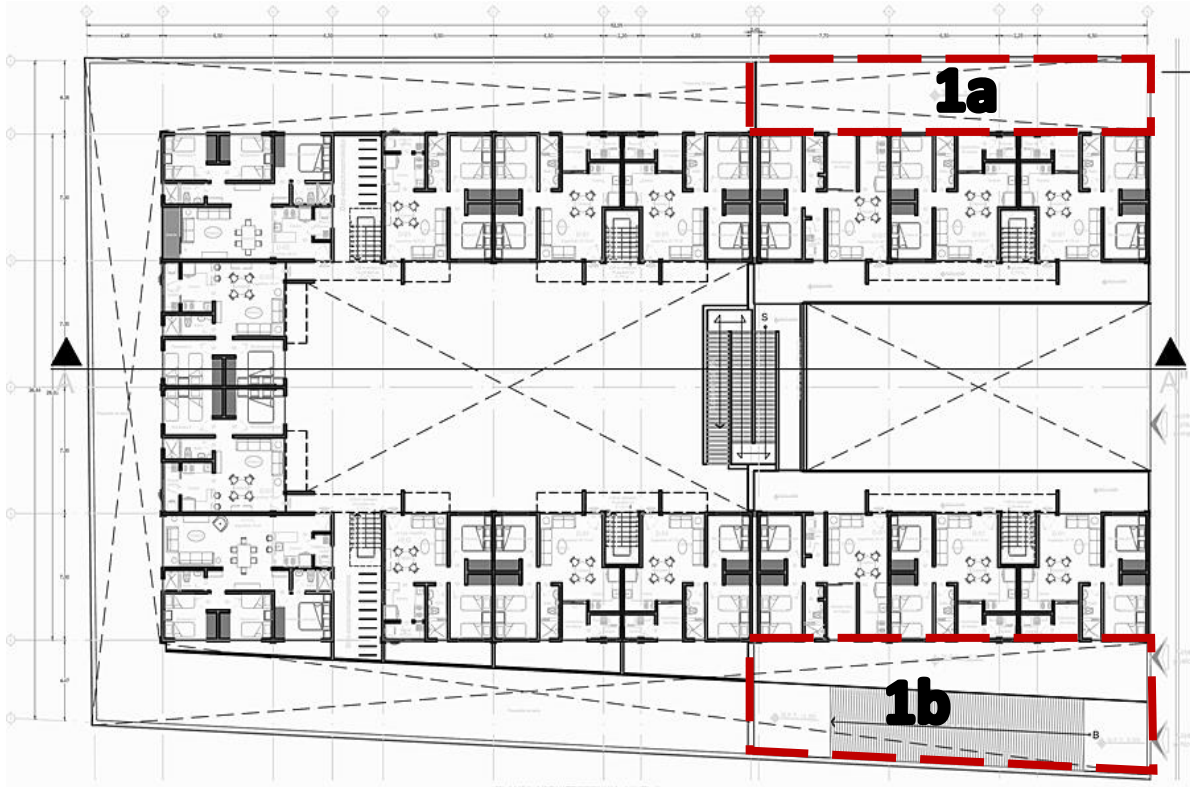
Plano arquitectónico (planta nivel 1).
